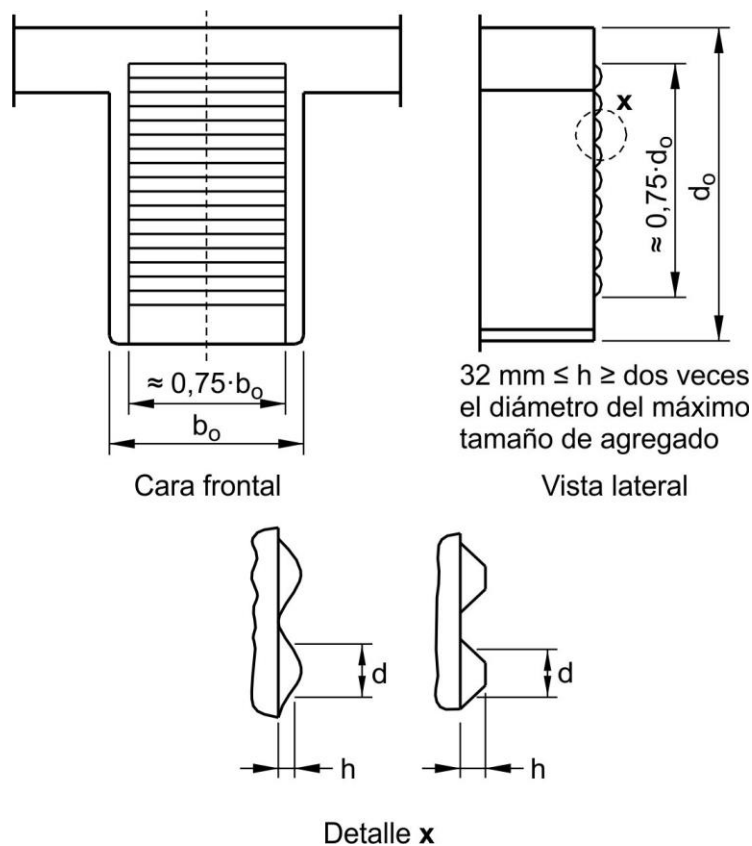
Ejemplo de conectores de corte de pequeña amplitud
